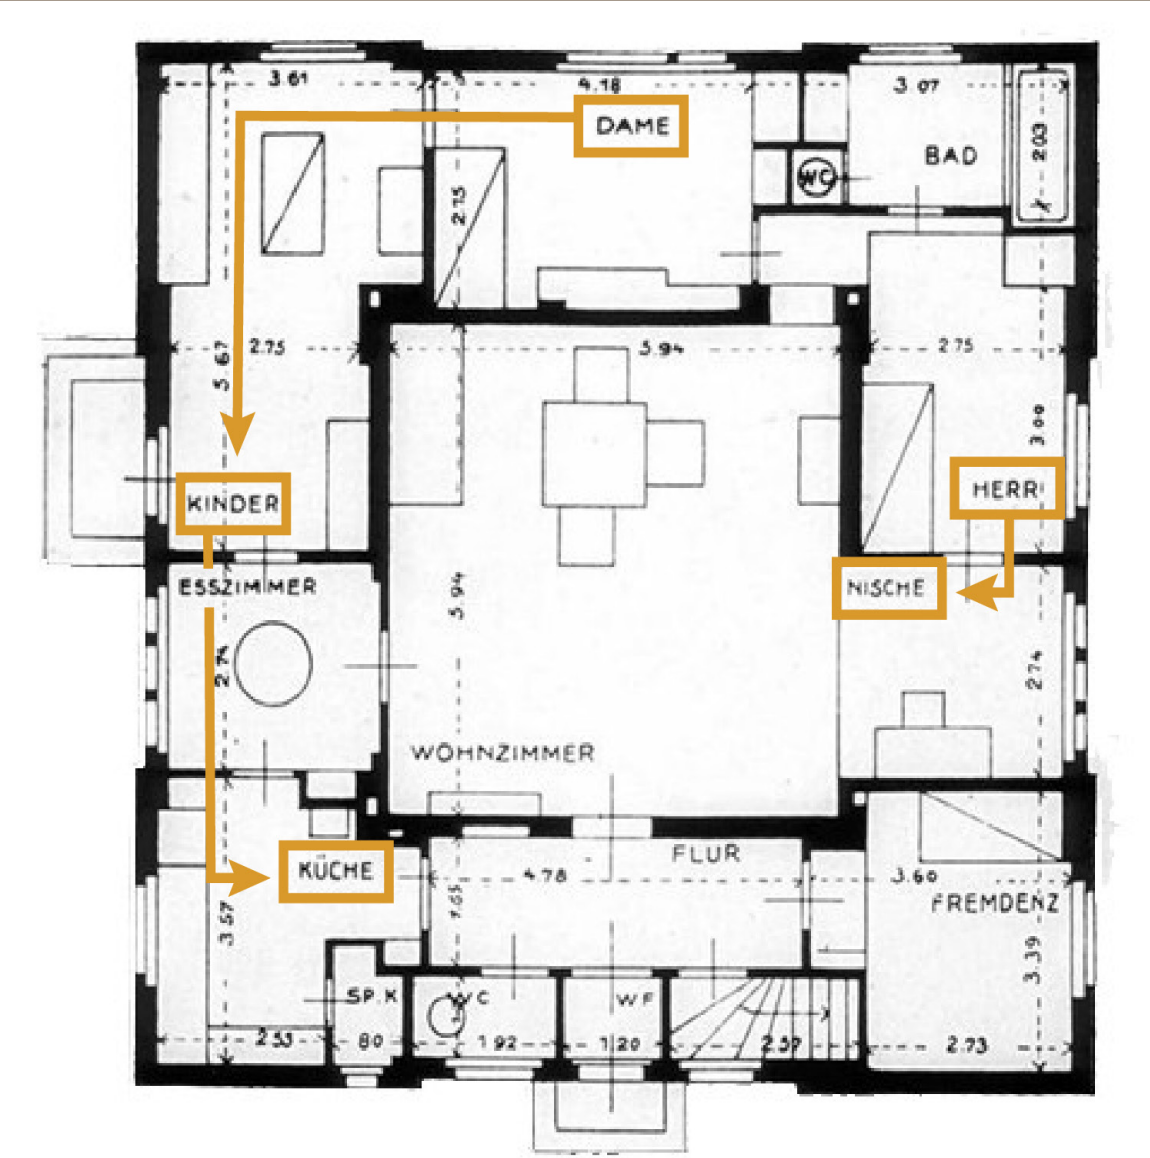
Grundriss Haus am Horn (Eigene Darstellung auf Grundlage von Gropius o.J.)
